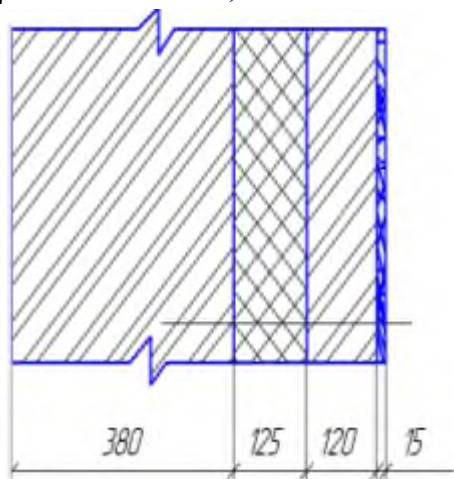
Схема наружной стены неоднородной кладки с утеплителем.
